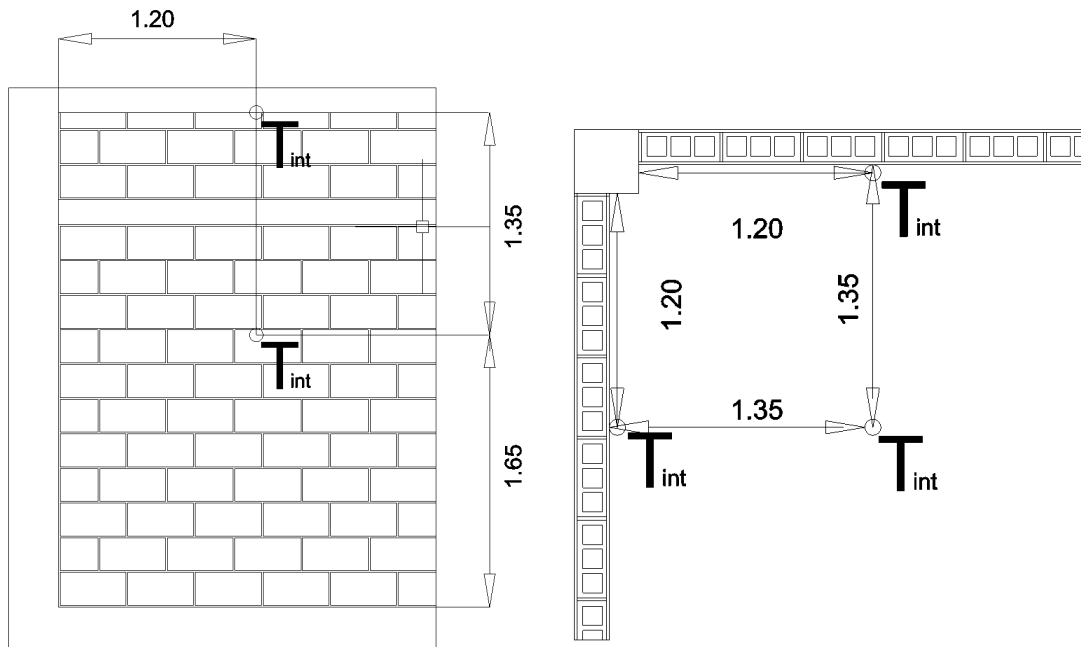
Ubicación de termopares en muro y en planta de intersección de muros (metros)
